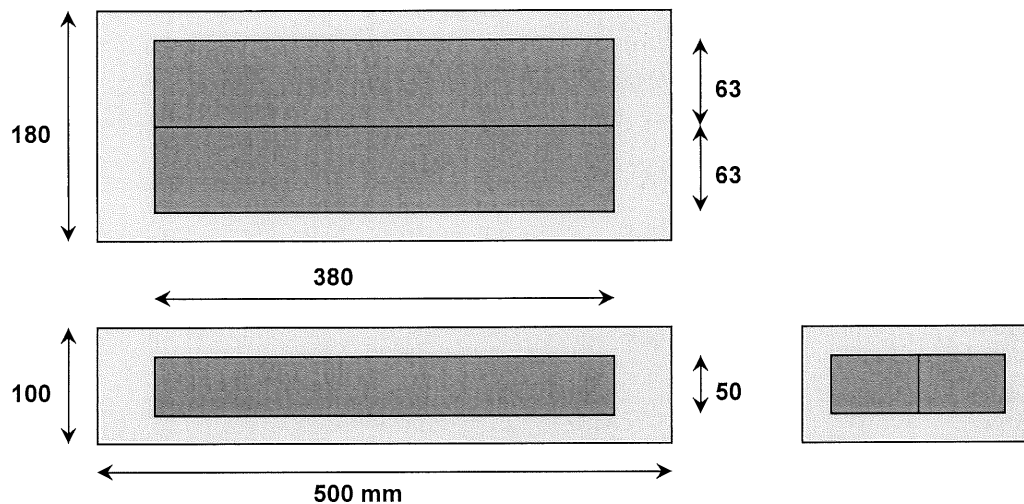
Plan de découpage des poutres dans la plaque.
